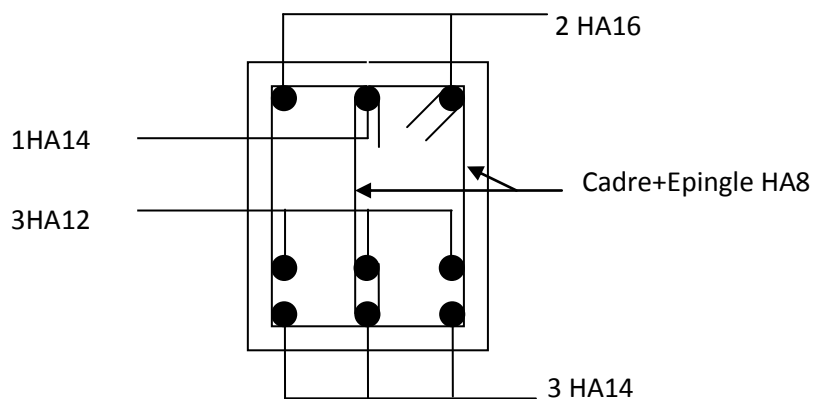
Schéma de ferrailage de la poutre de chaînage type II.
